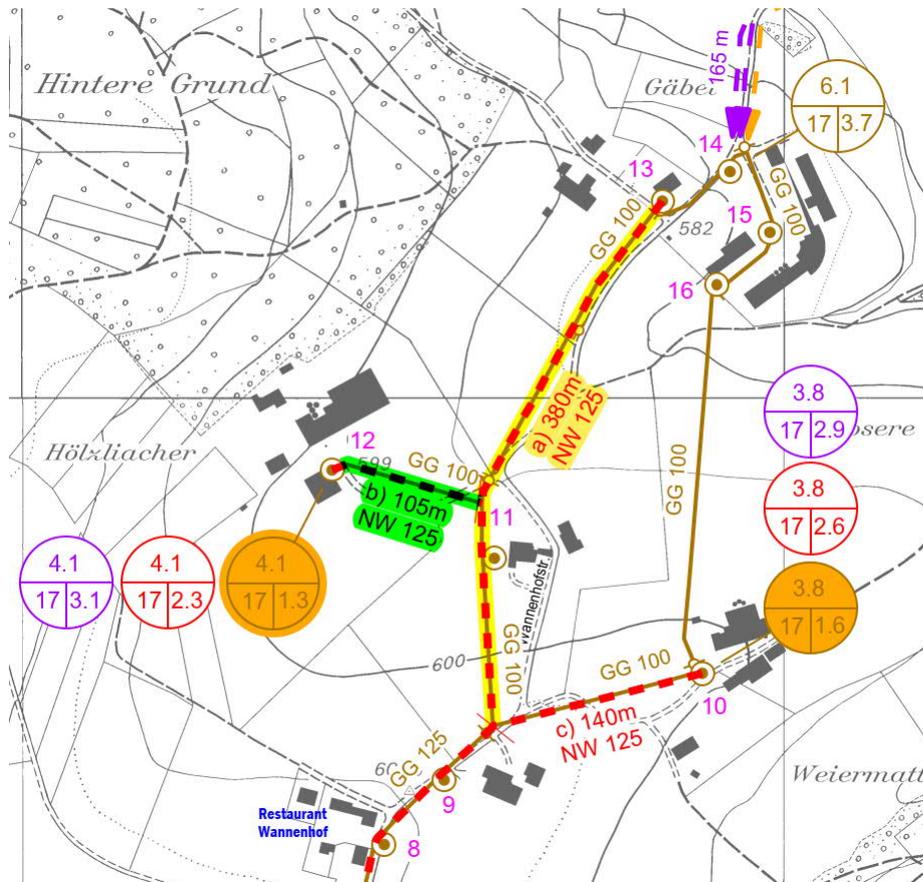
Ausschnitt aus dem GWP-Übersichtsplan 1:5'000
